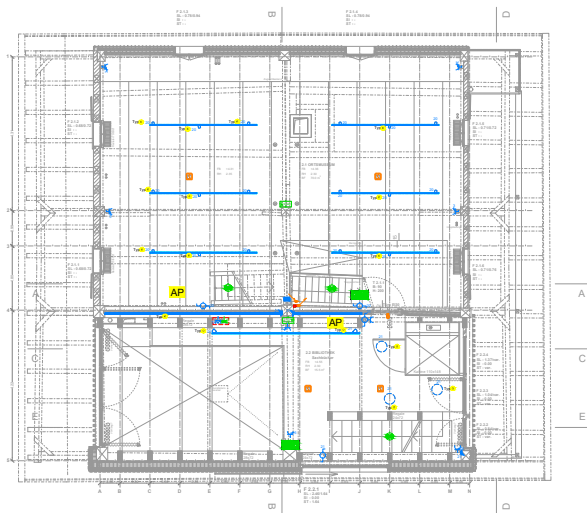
Grundriss 2. OG Elektro Konzept
